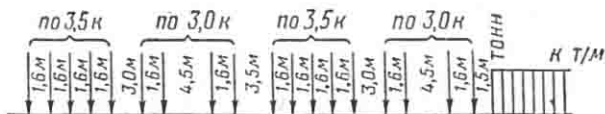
Схема расчетной временной вертикальной нагрузки НК
